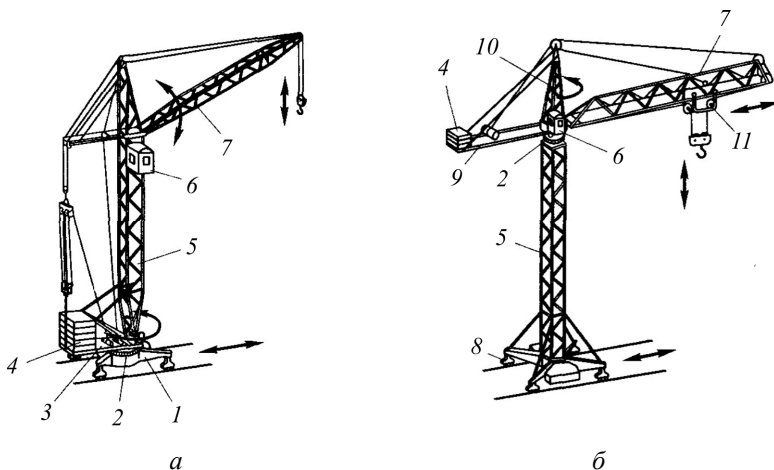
Башенные краны: *а* – кран с поворотной башней и подъемной стрелой; *б* – кран с неповоротной башней и балочной стрелой; 1 – рама; 2 – опорно-поворотное устройство; 3 – платформа; 4 – противовес; 5 – башня; 6 – кабина; 7 – стрела; 8 – ходовая тележка; 9 – консоль; 10 – оголовок; 11 – грузовая тележка
